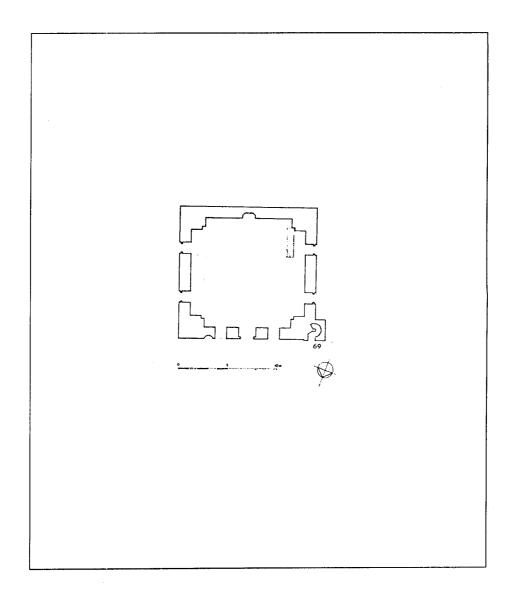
مسقط أفقي لتربة بايزيد يلدريم في بورصة (أو بروسه) (عن : Wilde) .
